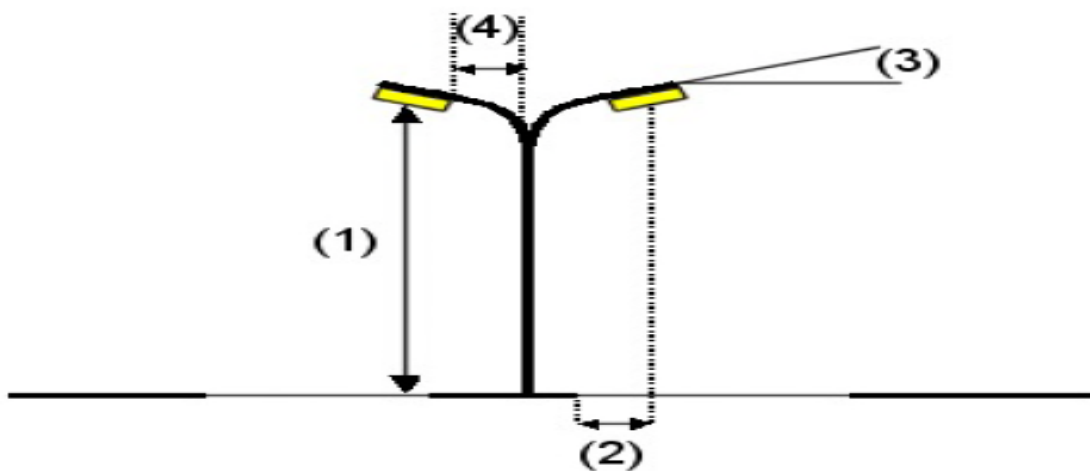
Paramètres d'implantation des candélabres de la voie. [2]
